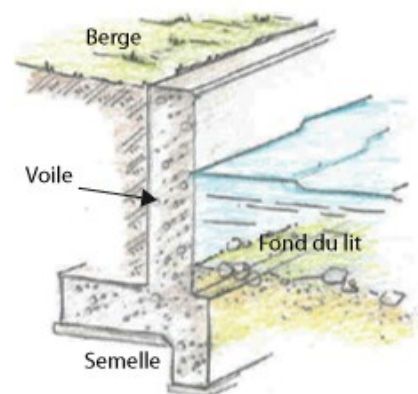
Schéma de coupe d'un mur de soutènement avec semelle.
